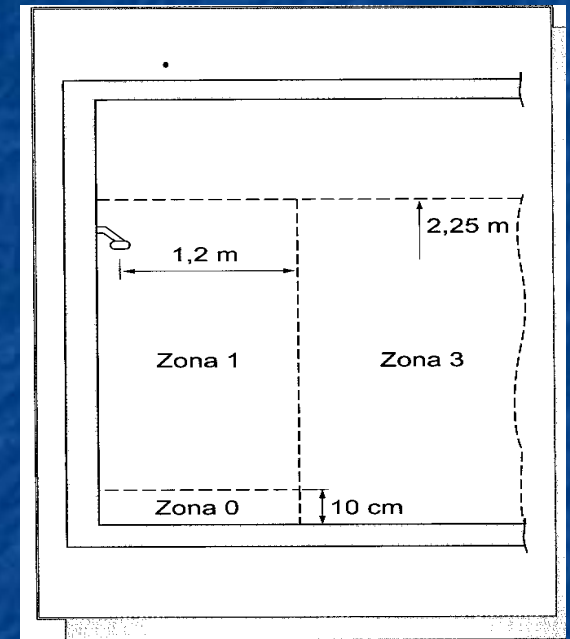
Zone di rispetto in un locale doccia senza piatto doccia, secondo la nuova norma (sezione).
